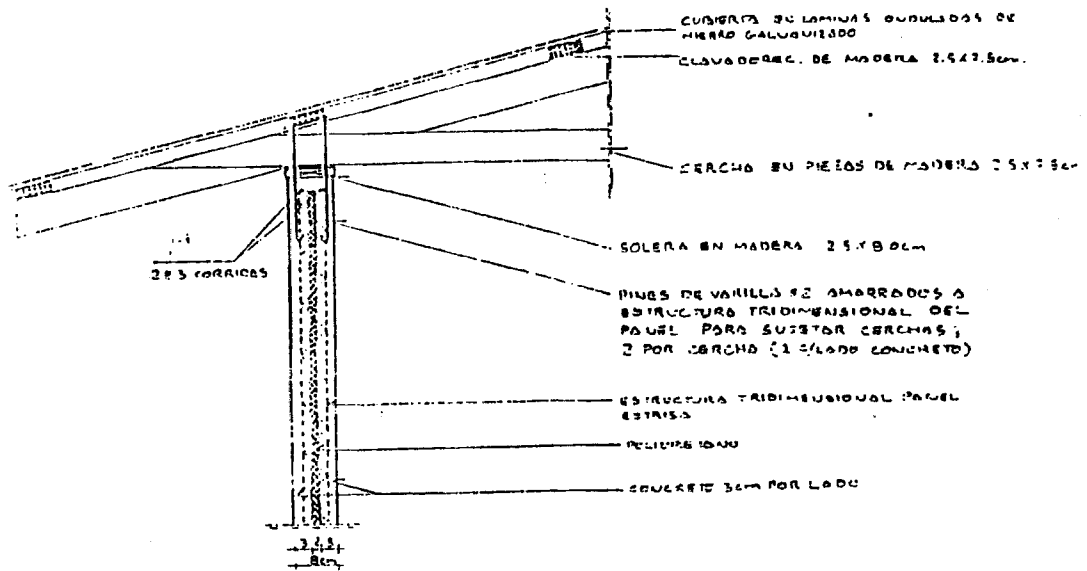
ANCLAJE DE CERCHA SOBRE MURO (SISTEMA ESTRISA)
